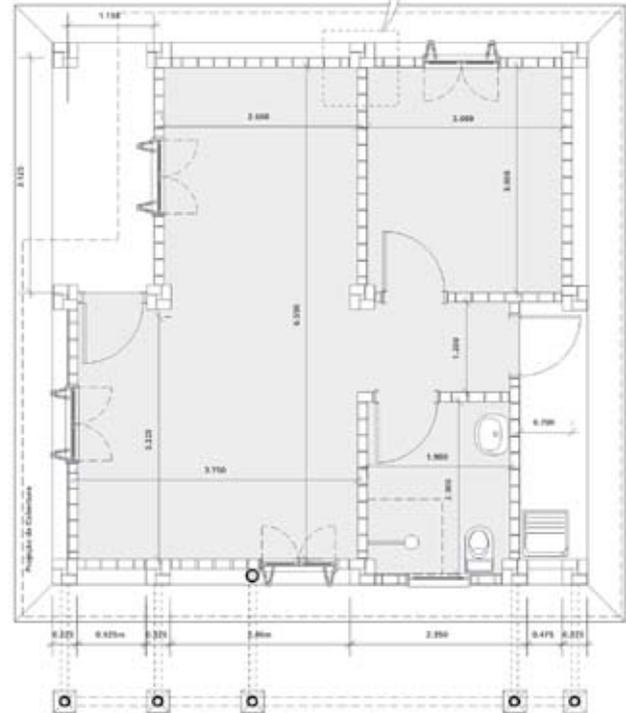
Modulação das fiadas de assentamento dos tijolos
